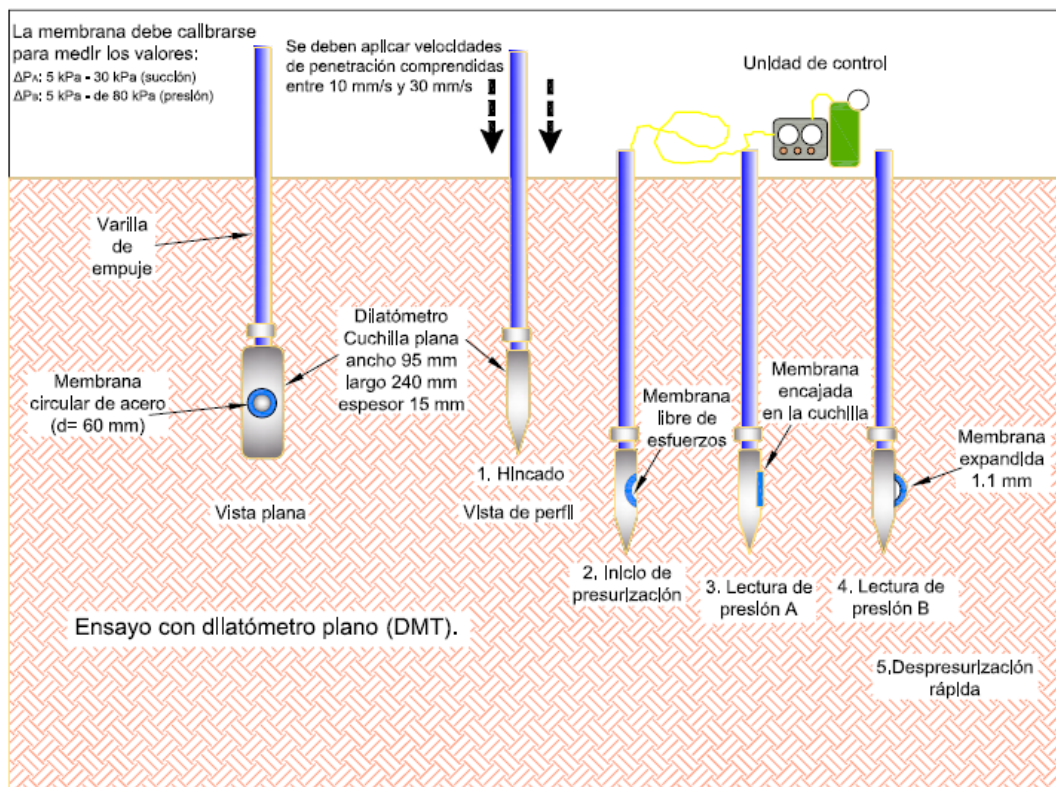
Ensayo del dilatómetro plano (DMT)
